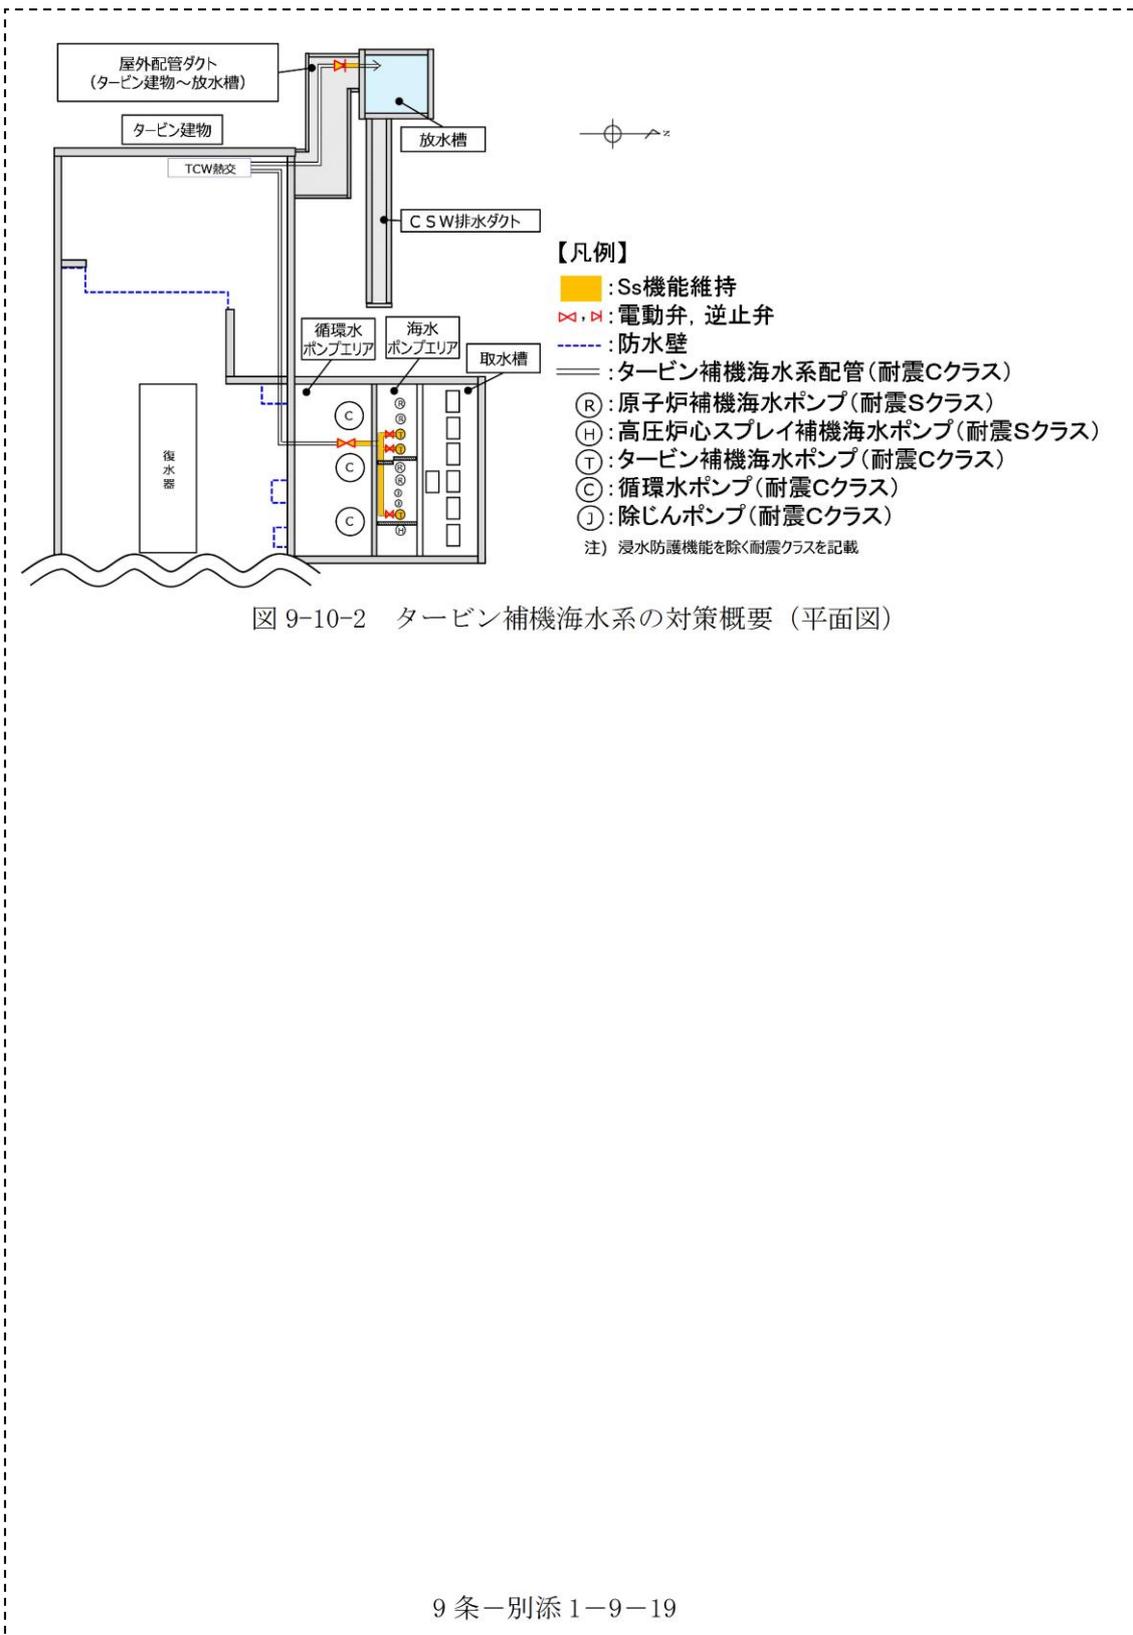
タービン補機海水系の対策概要 (平面図)
